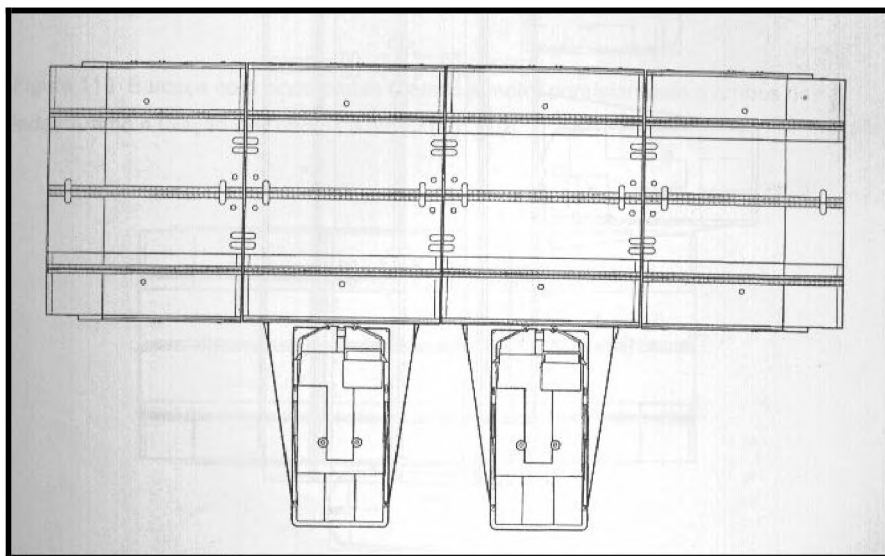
Portada de quatro módulos com embarcações perpendiculares à faixa de rodagem
